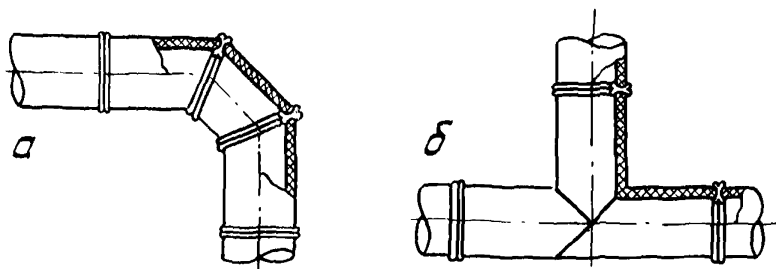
Сварные стыковые соединения труб со сварными соединительными деталями:
